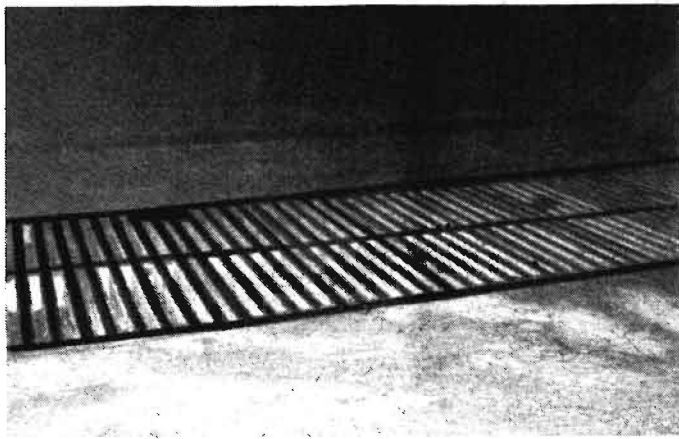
Spaltenbodenelemente KLZF-2045 vor der Einlagerung
